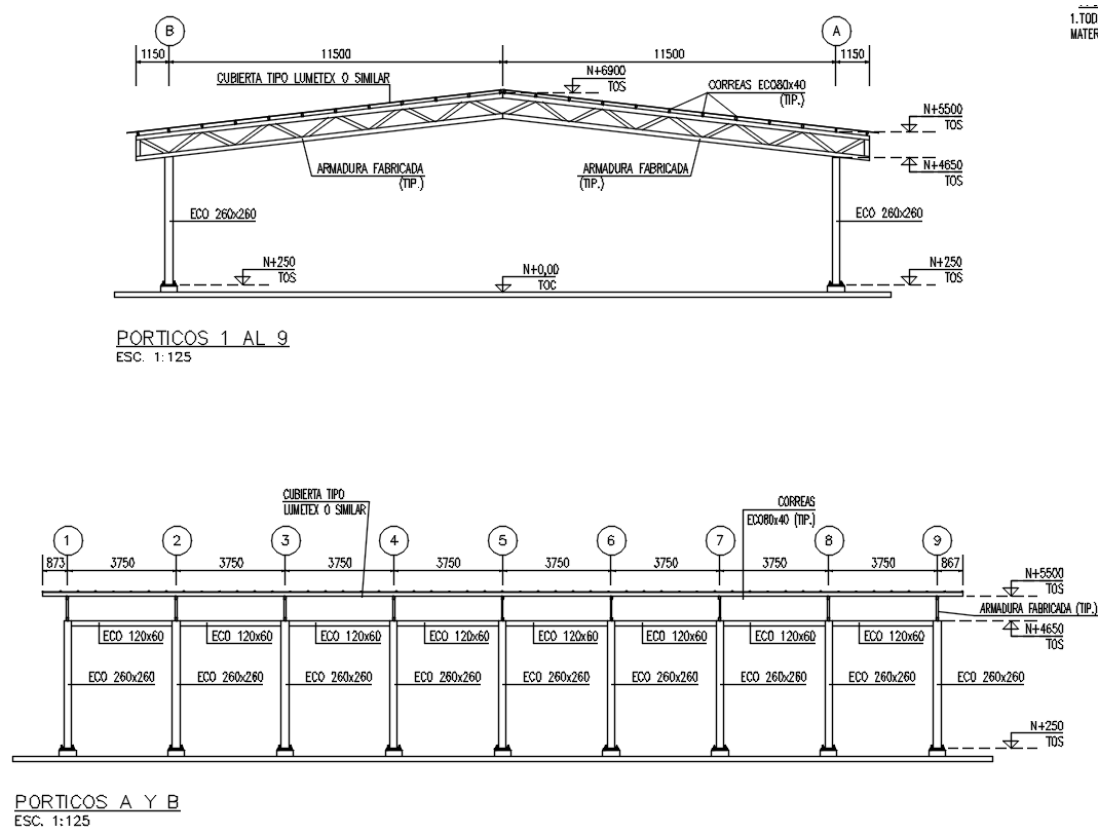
Pórticos de estructuración propuesta de la exoestructura del ala izquierda del EN7. Fuente: Autor.
